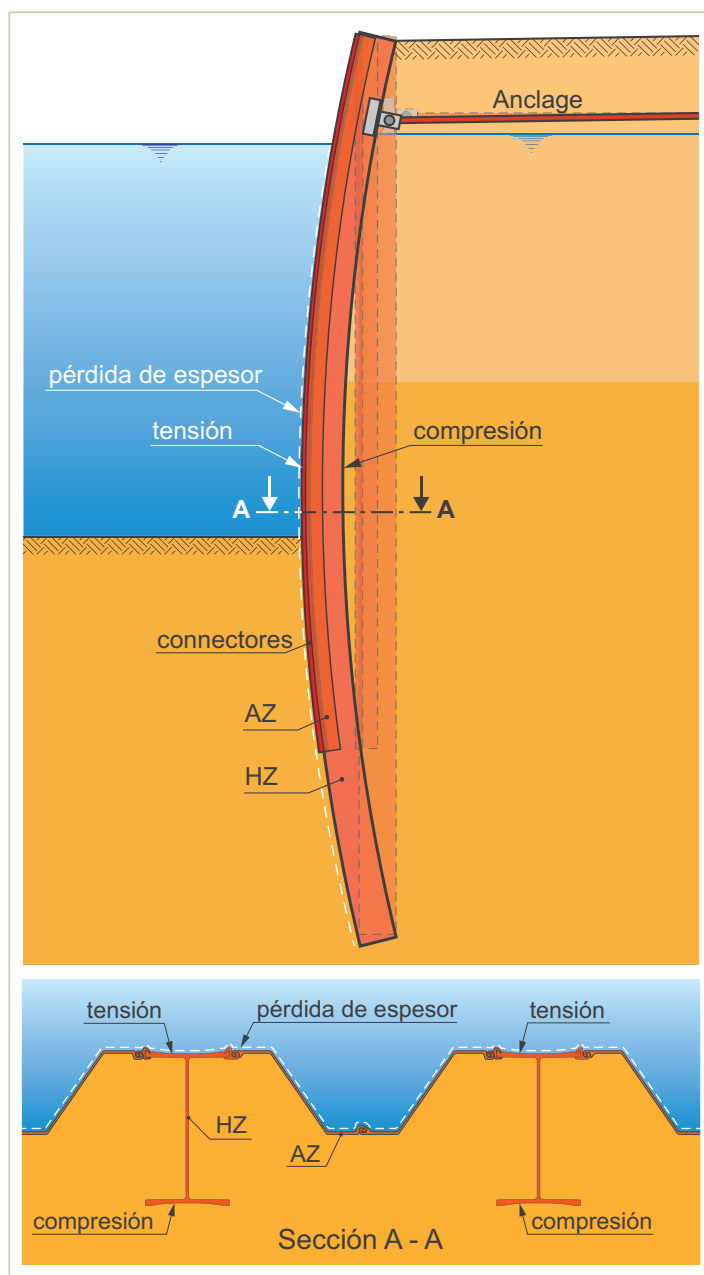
Configuración típica de sistema de muro HZ/AZ (sección tipo).
